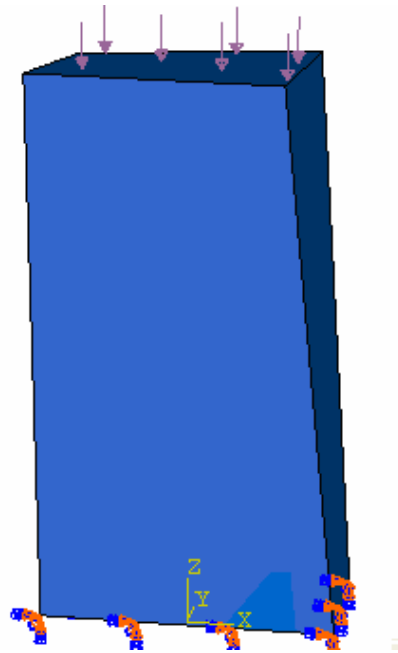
Rappresentazione dei vincoli applicati al pilastro 23
